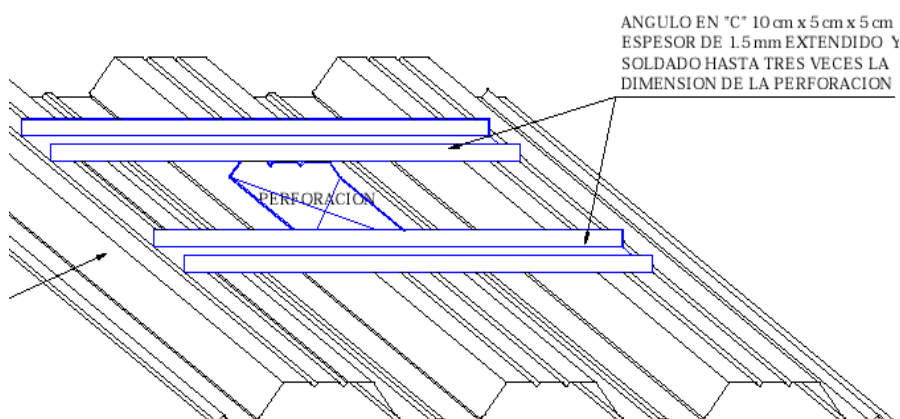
Colocación de perfiles para reforzar la lámina colaborante cuando se hacen las perforaciones.
